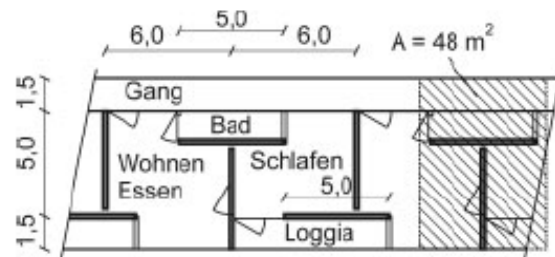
Grundriss von Tragwerkstyp II [7]
